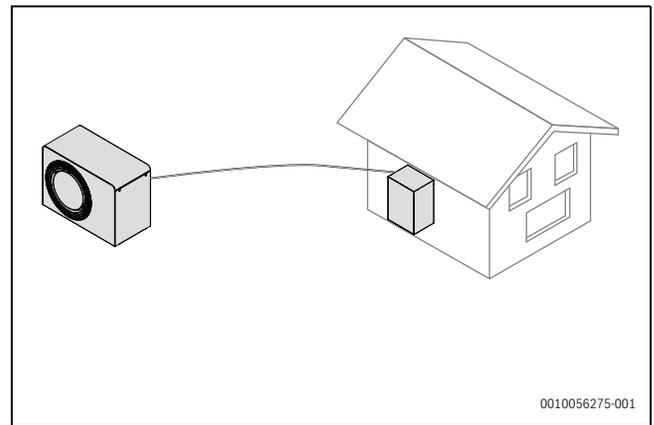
Collegamento CAN-BUS tra l'unità interna e l'unità esterna
